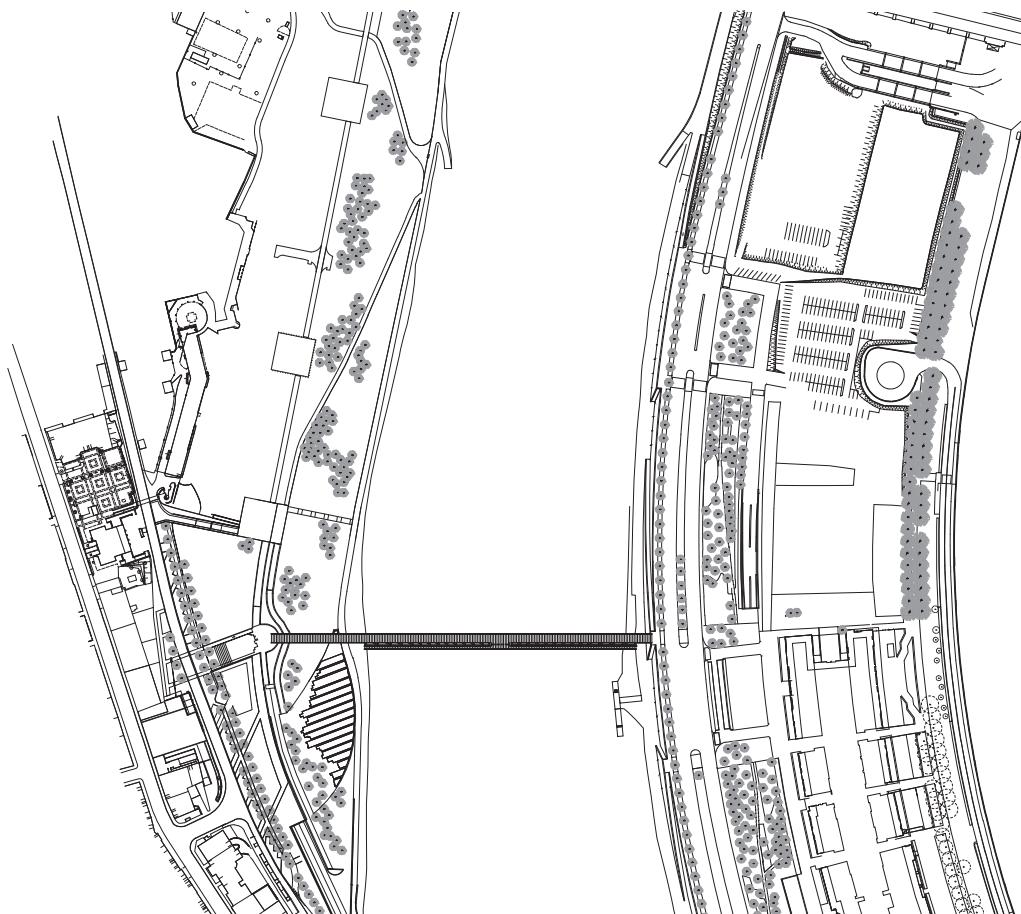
Ortofoto di riferimento e planimetria di posizionamento
